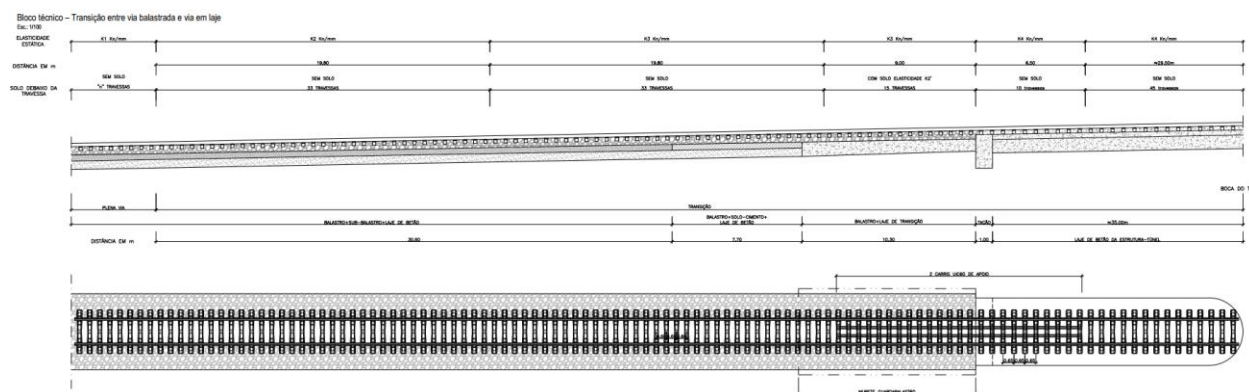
Bloco Técnico - Transição entre via balastrada e via em laje
